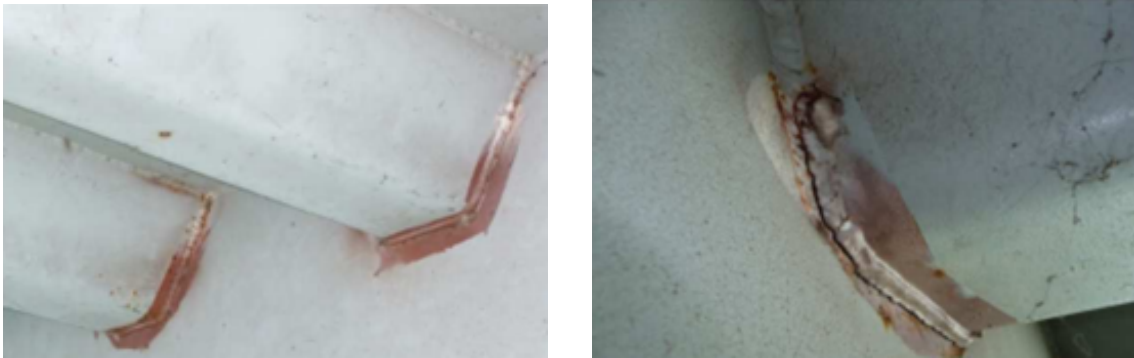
Pont d'Illzach : Fissuration à la jonction auget discontinu-pièce de pont [13].
